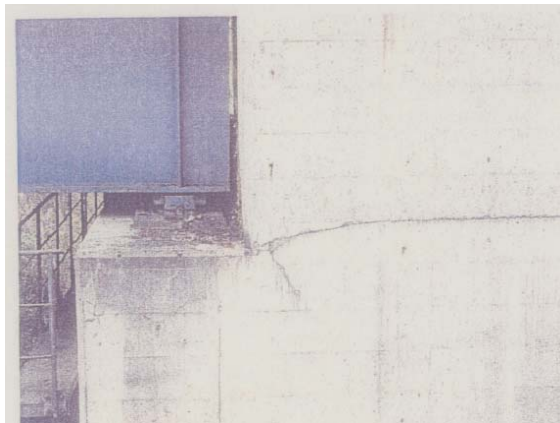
上り線かけ違い橋脚 P1 上パラペット基部に生じたひび割れ
